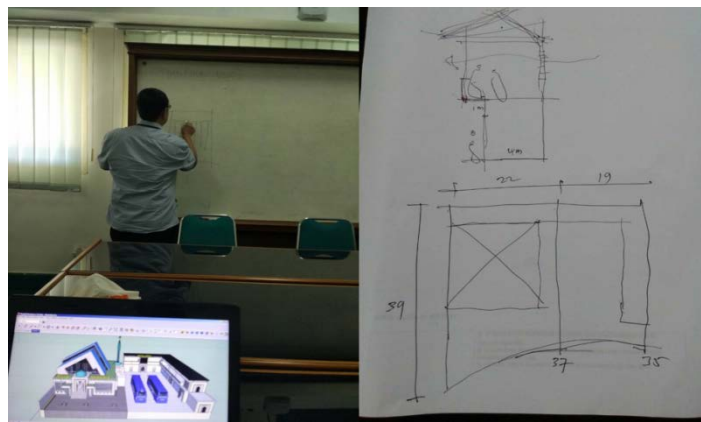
Penampilan bangunan yang menggunakan unsur bentukan yang mudah dipahami
